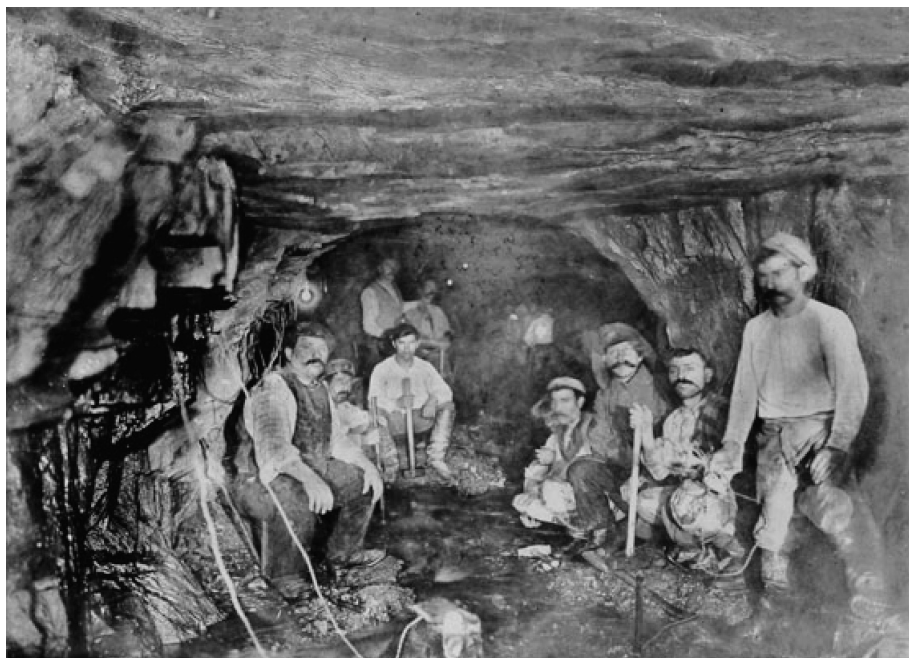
Obreros en la construcción del túnel. Foto del archivo del ingeniero Katzenstein.
